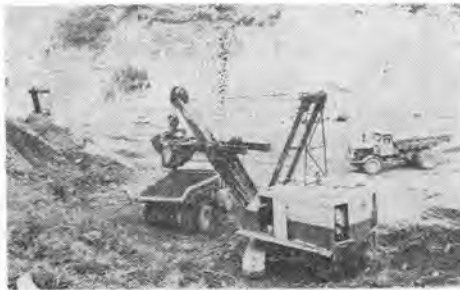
ダム上流左岸掘削状況 (機械稼働状況)
